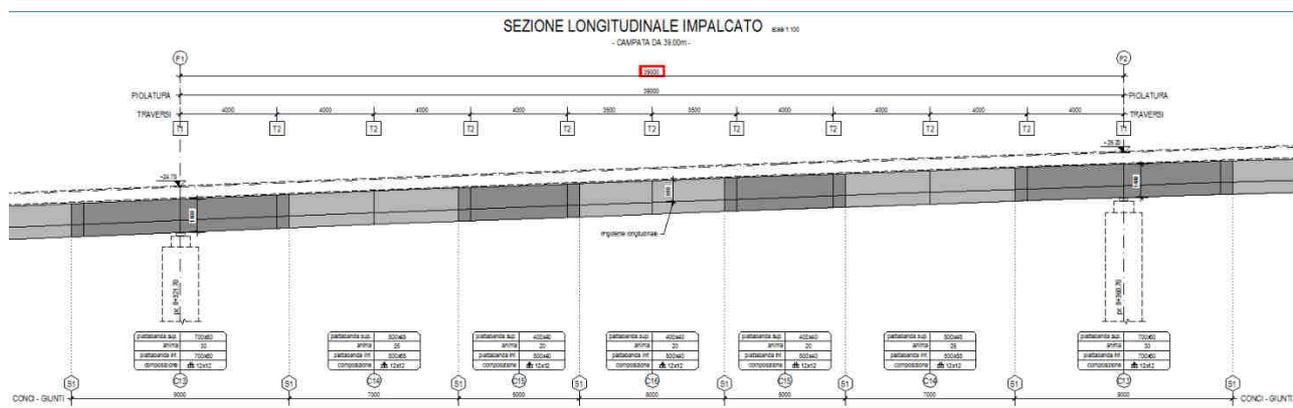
Campata particolare da 39,0m - Viadotto Selargius Centro
